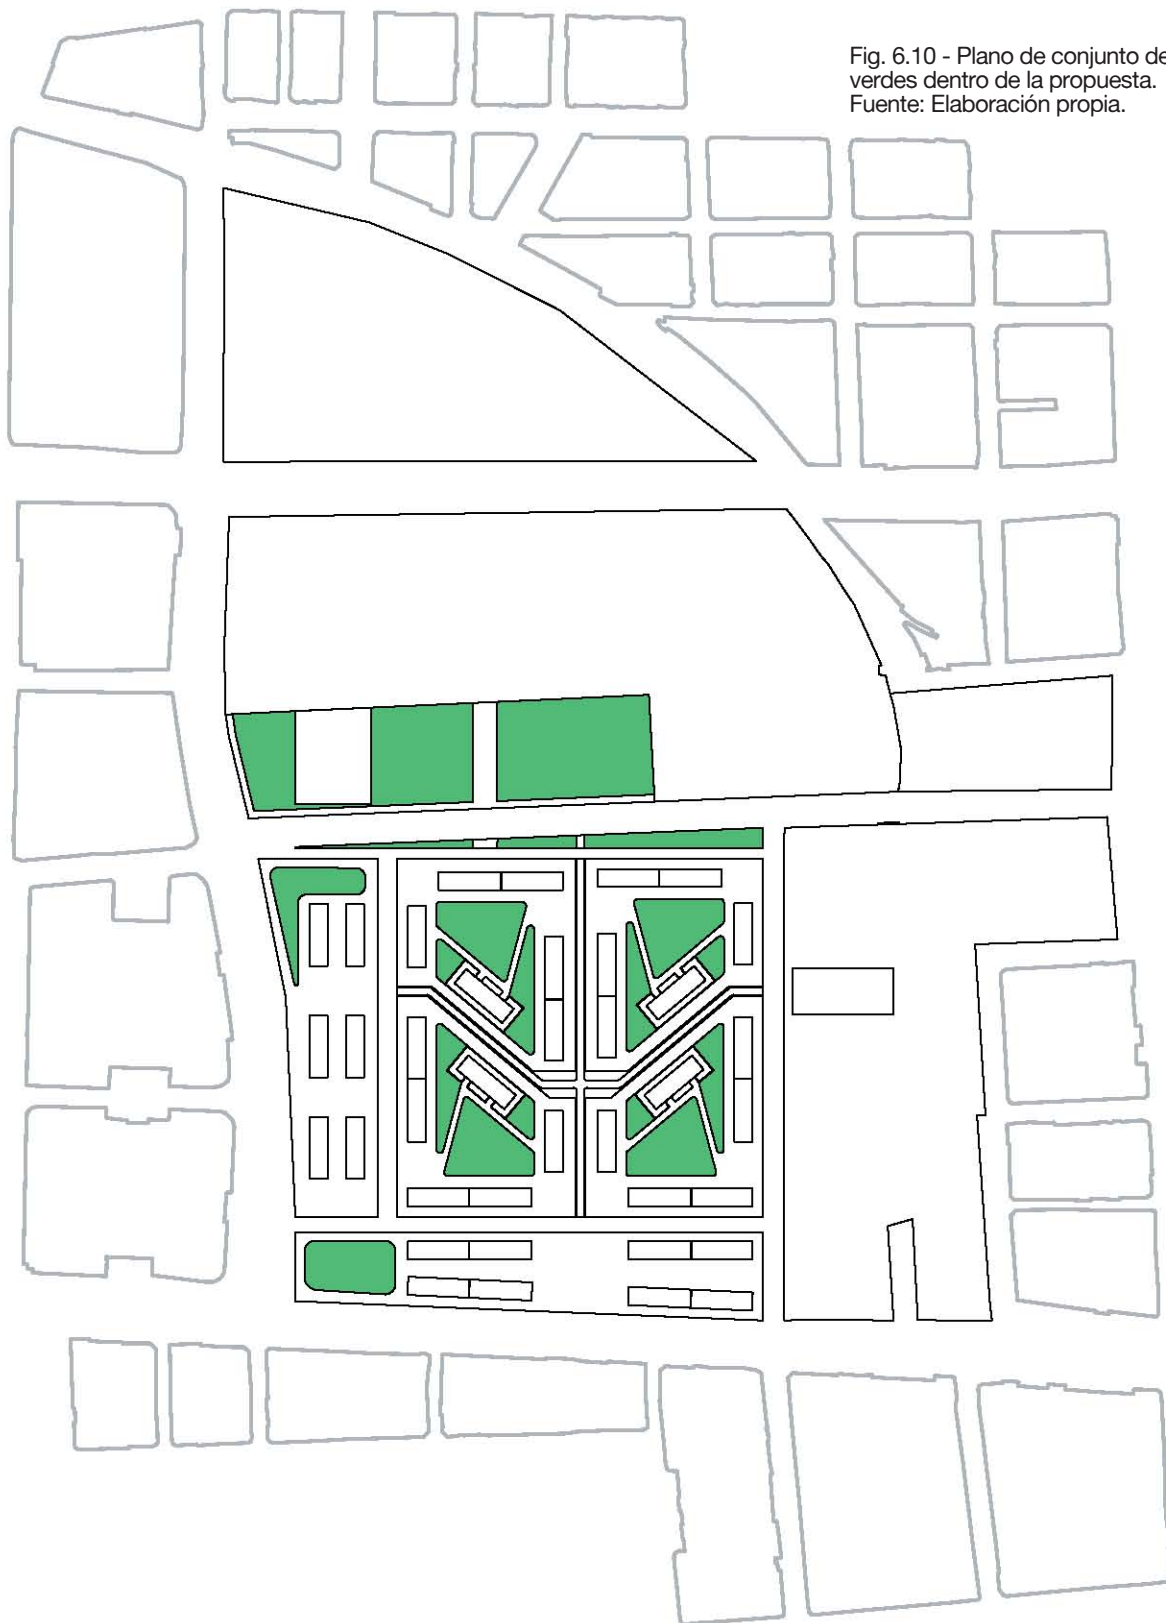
Plano de conjunto de las áreas verdes dentro de la propuesta.
